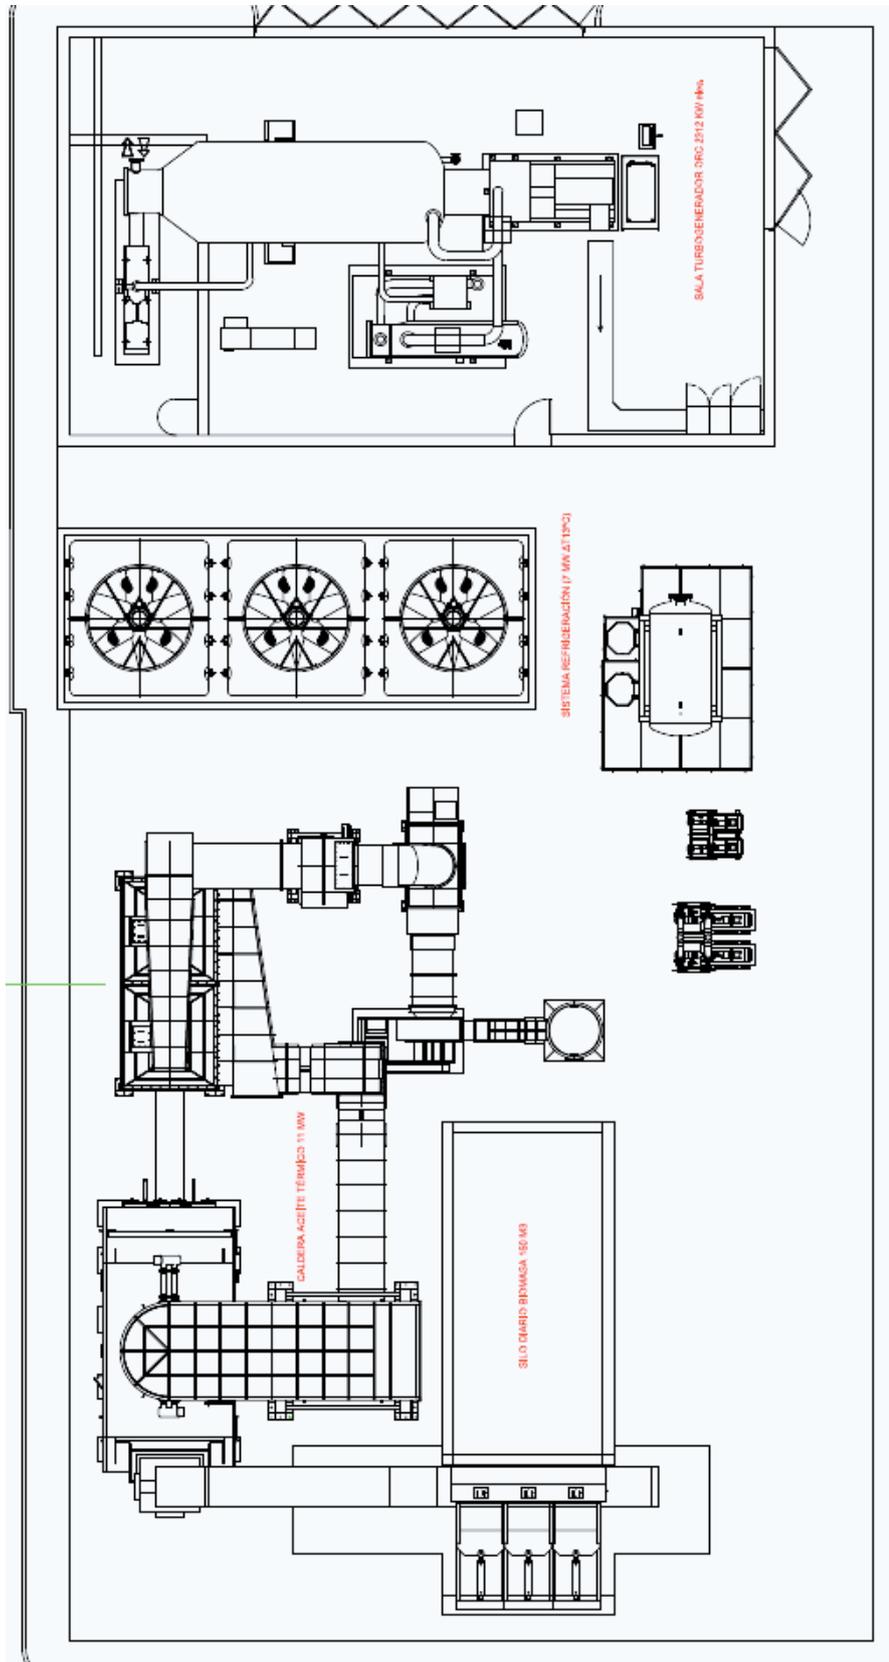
Plano en planta de instalaciones, infraestructuras y equipos. Detalle de la zona de proceso.
